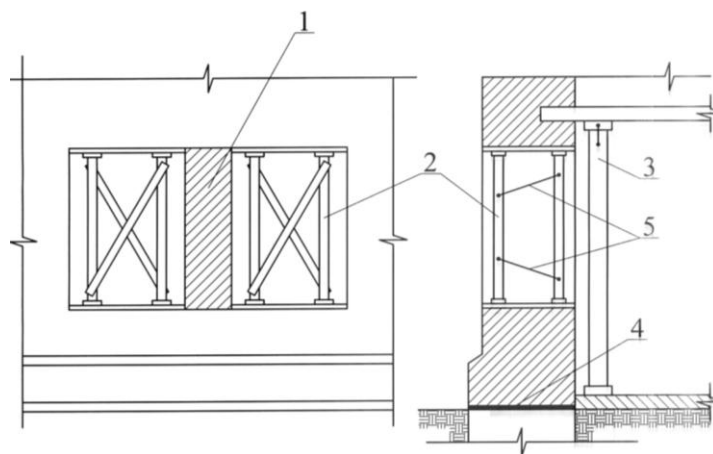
Временное крепление конструкций при перекладке простенка: 1 – перекладываемый простенок; 2 – стойки под перемычкой; 3 – стойки под перекрытием; 4 – гидроизоляция; 5 – строительная скоба
